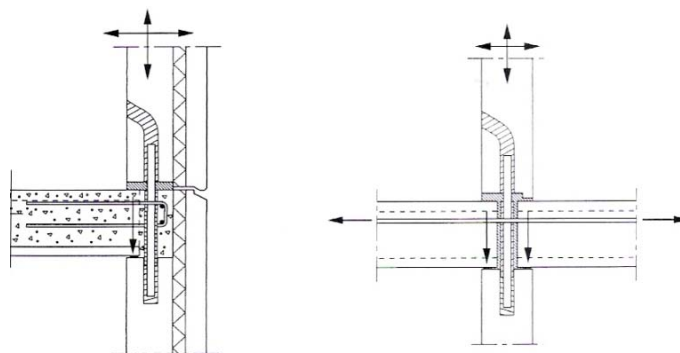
Ligações Laje – Parede (extraída de [10])
